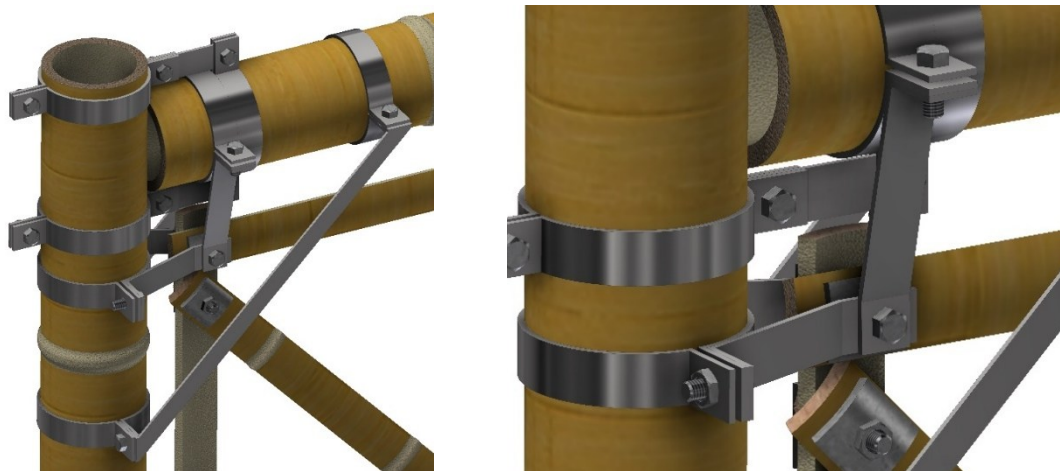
Detalle de conexión propuesta para el ensamble panel – muro.
